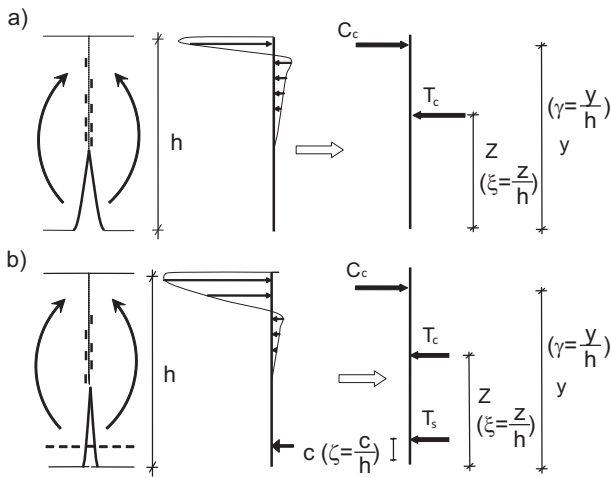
Comportamiento de una sección fisurada a flexión: a) sección sin armado; b) sección con armadura
